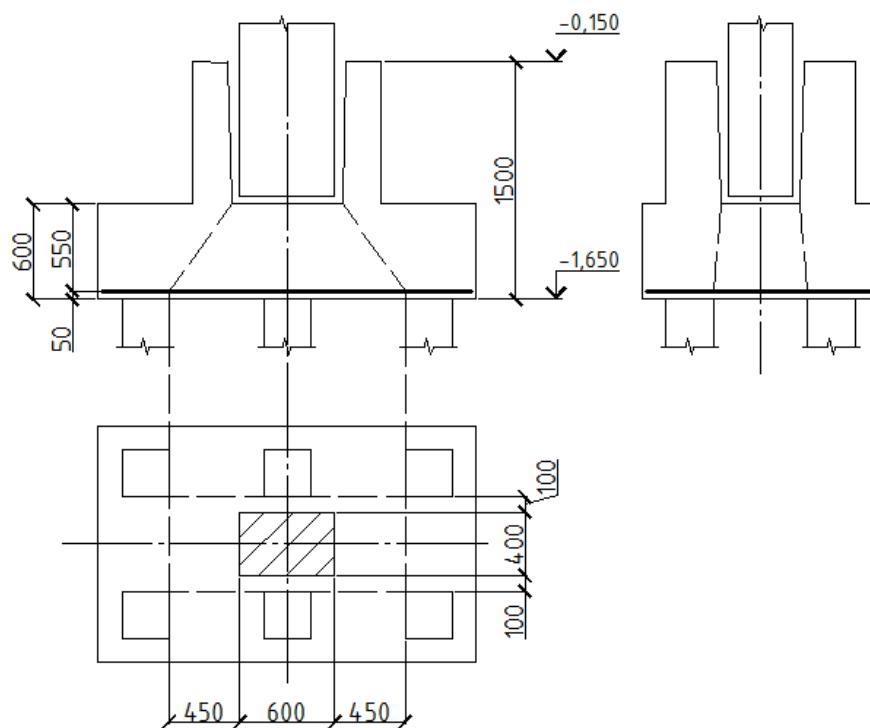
Схема работы ростверка на продавливание колонной
